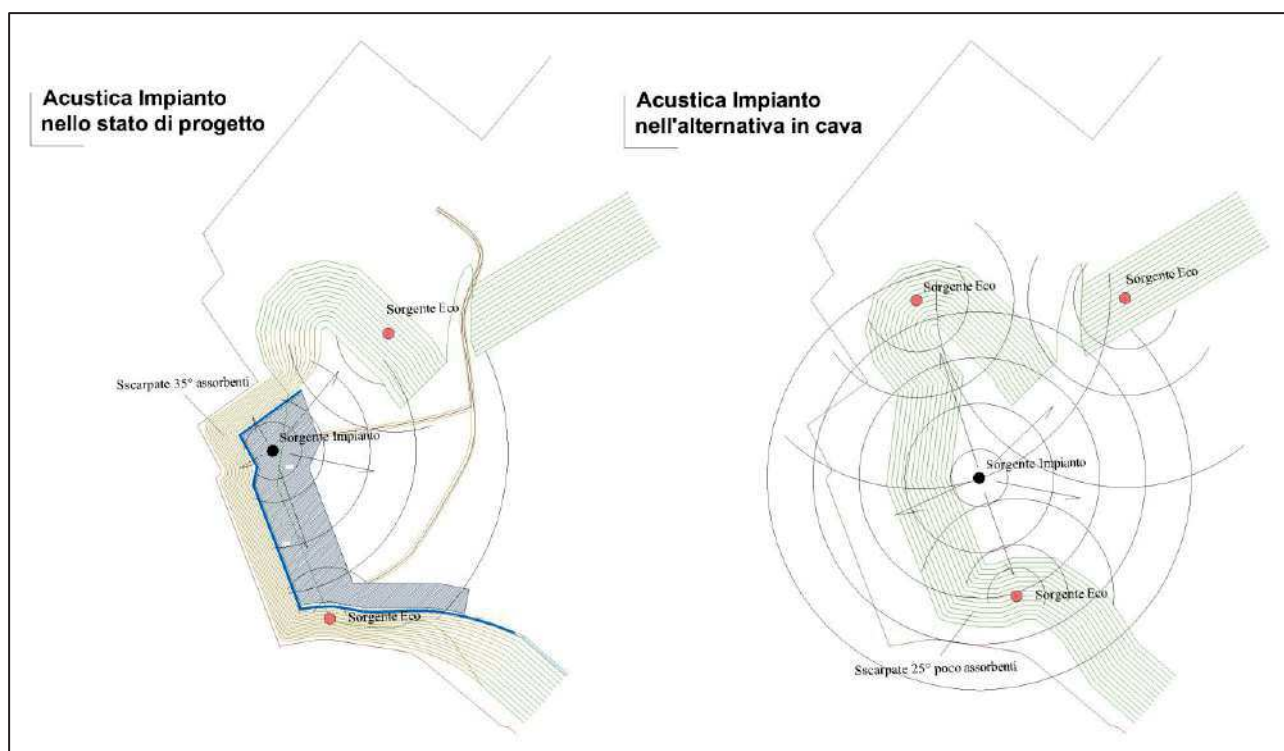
Rappresentazione visiva della propagazione del riverbero (ECO) indotto dall'impianto a confronto tra l'impianto interamente in cava e di progetto
